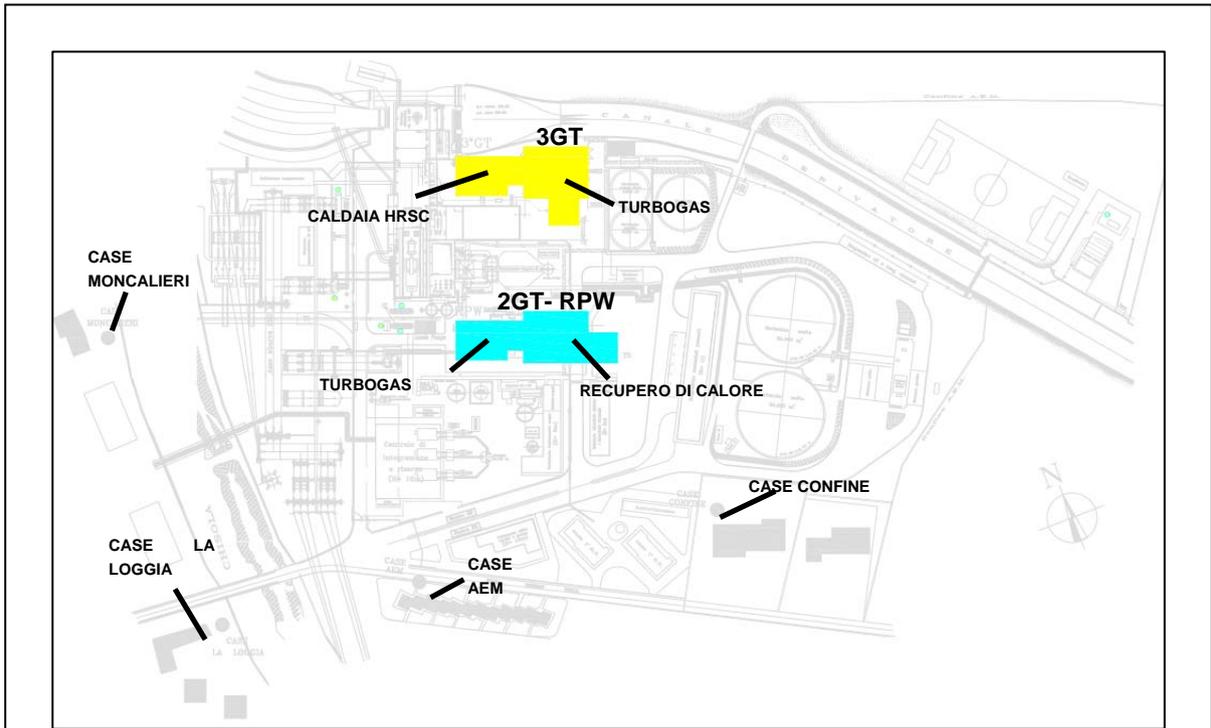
LAYOUT FASE DI PROGETTAZIONE INIZIALE
